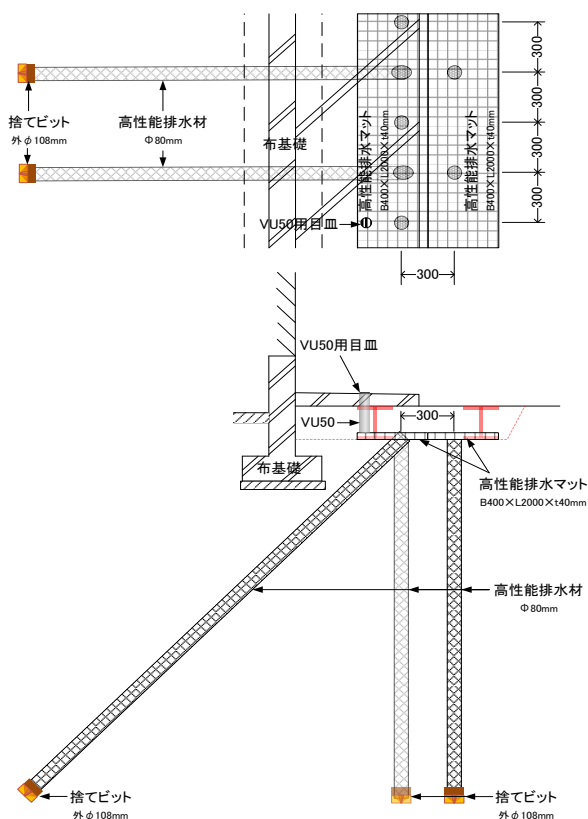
ドレーンの標準配置図(上:平面図, 下:断面図)
